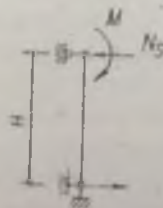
Определение усилия в анкере от изгибающего момента в уровне перекрытия
